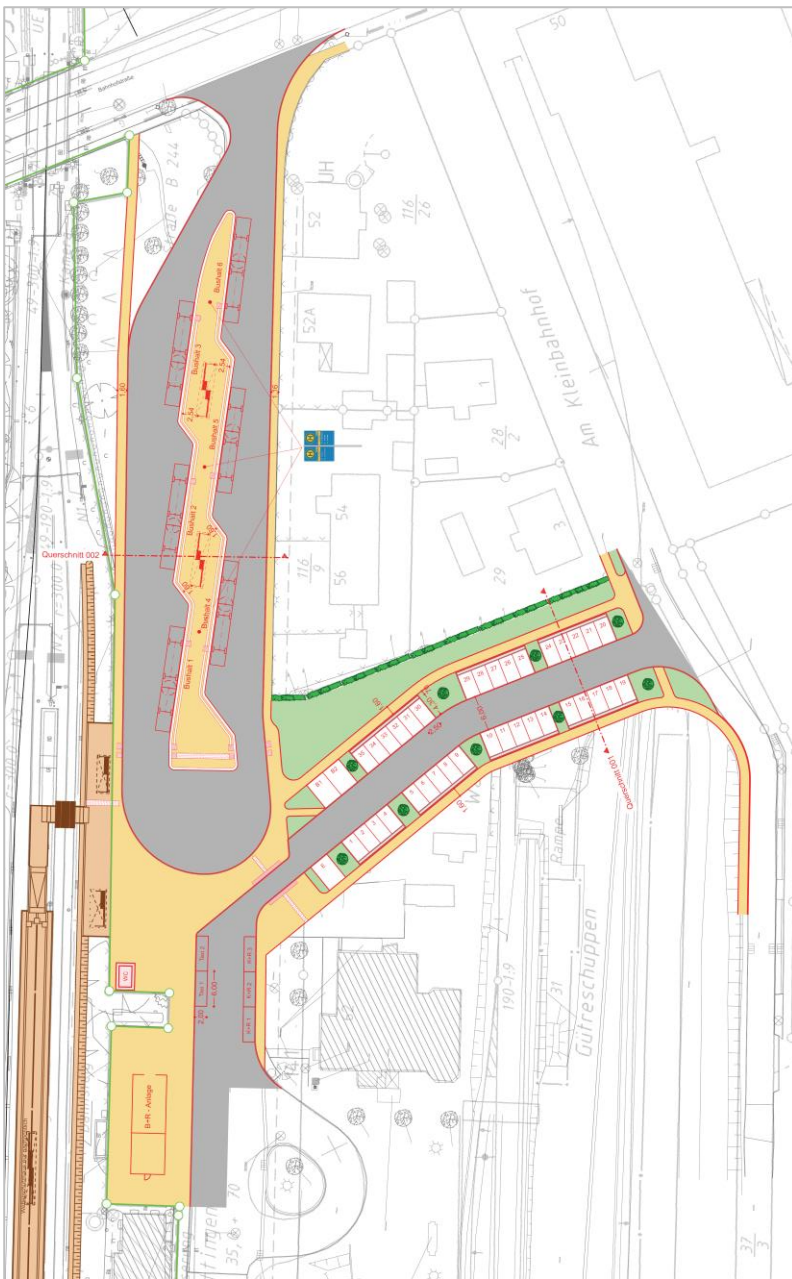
Lageplan Bahnhofsumfeld
